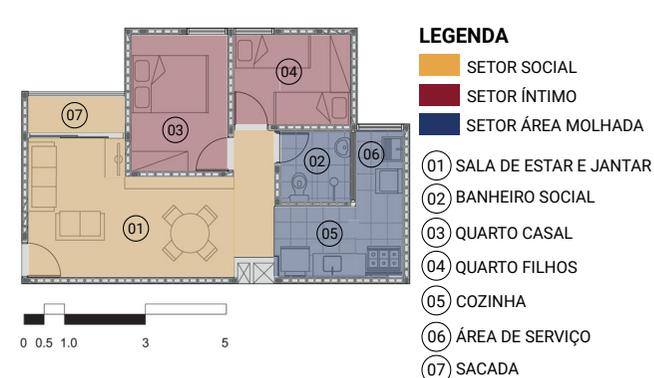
Planta baixa do apartamento tipo B. Fonte: Archdaily (2021), adaptado pela autora.
